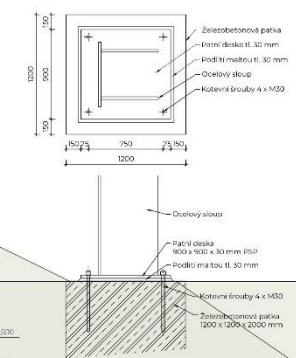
DETAIL NAPOJENÍ NA PŮVODNÍ KONSTRUKCI M 1:10
